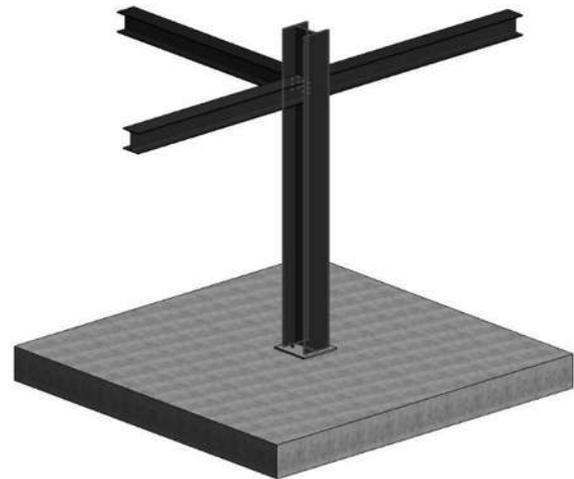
Esquema de estructura de acero. Fuente: Elaboración propia
